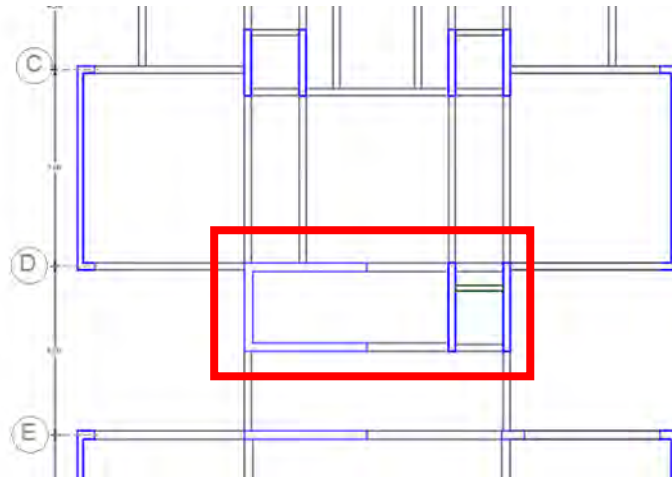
Vista en planta de las placas apoyadas en zapata Z-6
